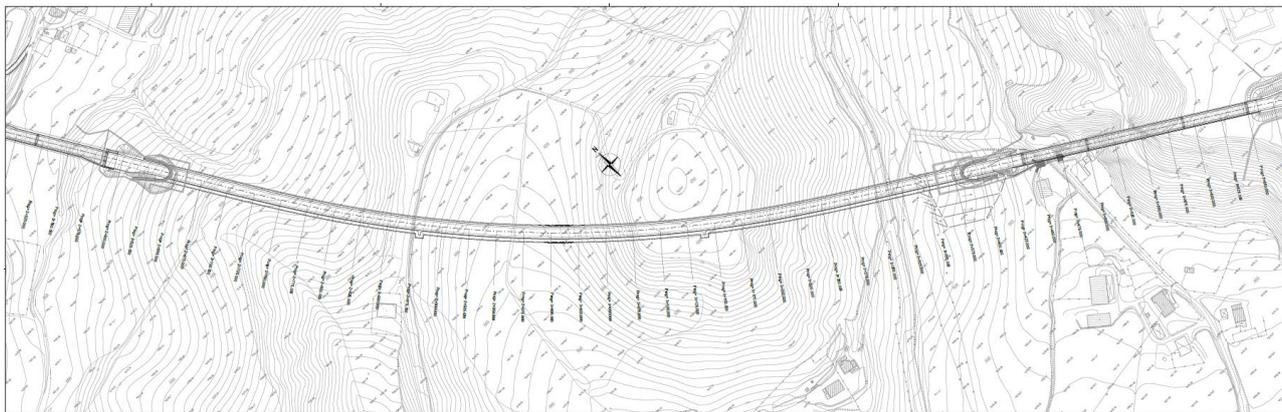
Stralcio planimetrico della galleria "Urbania II"
